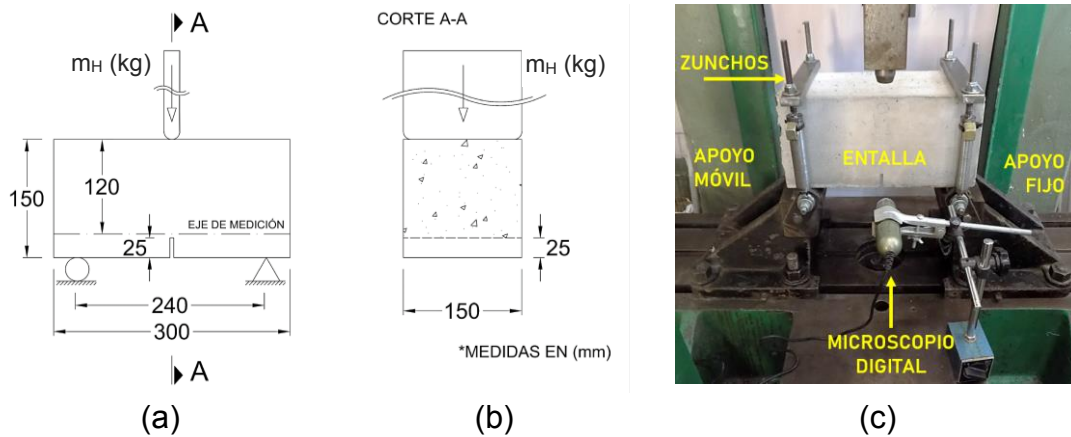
Probeta del ensayo de impacto: (a) Vista frontal y (b) corte transversal. (c) montaje de ensayo de impacto.
